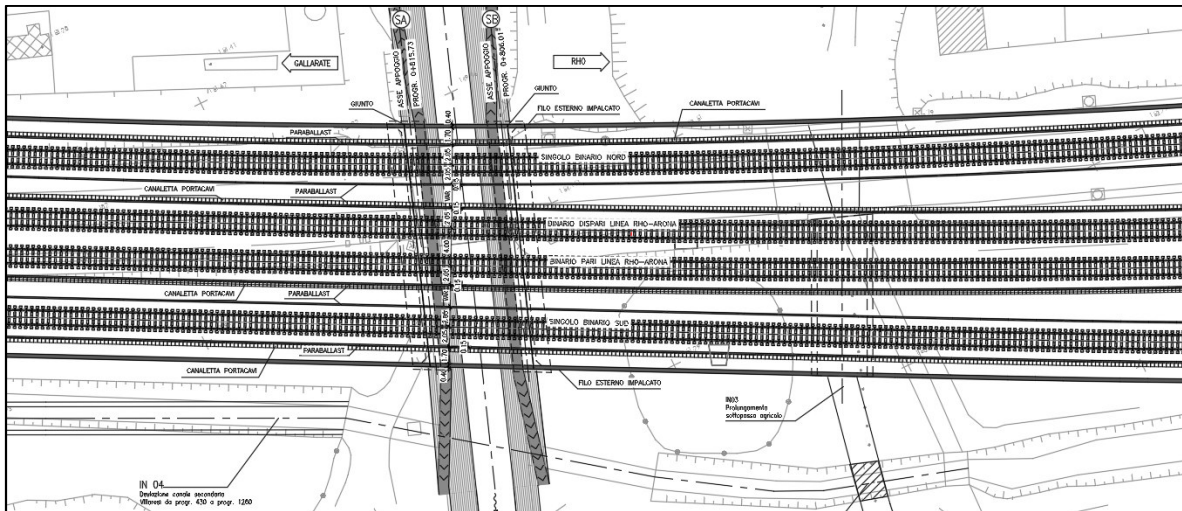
PLANIMETRIA NUOVO ATTRAVERSAMENTO FERROVIARIO SUL FIUME OLONA
